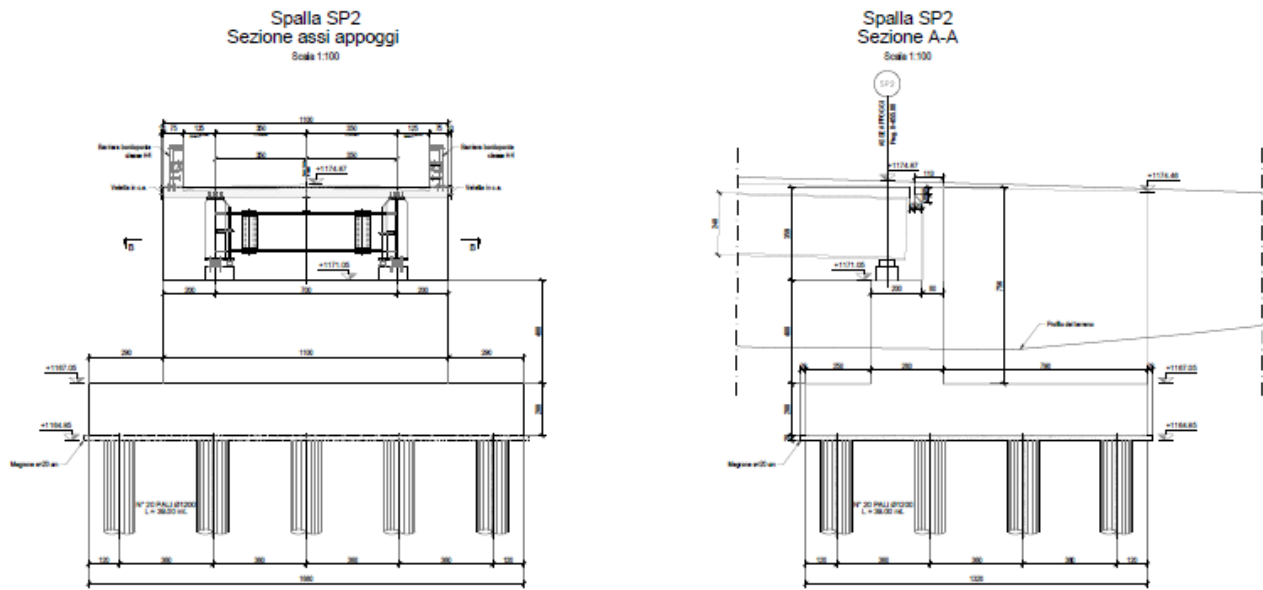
Ponte Rio - Carpenteria spalla 2
